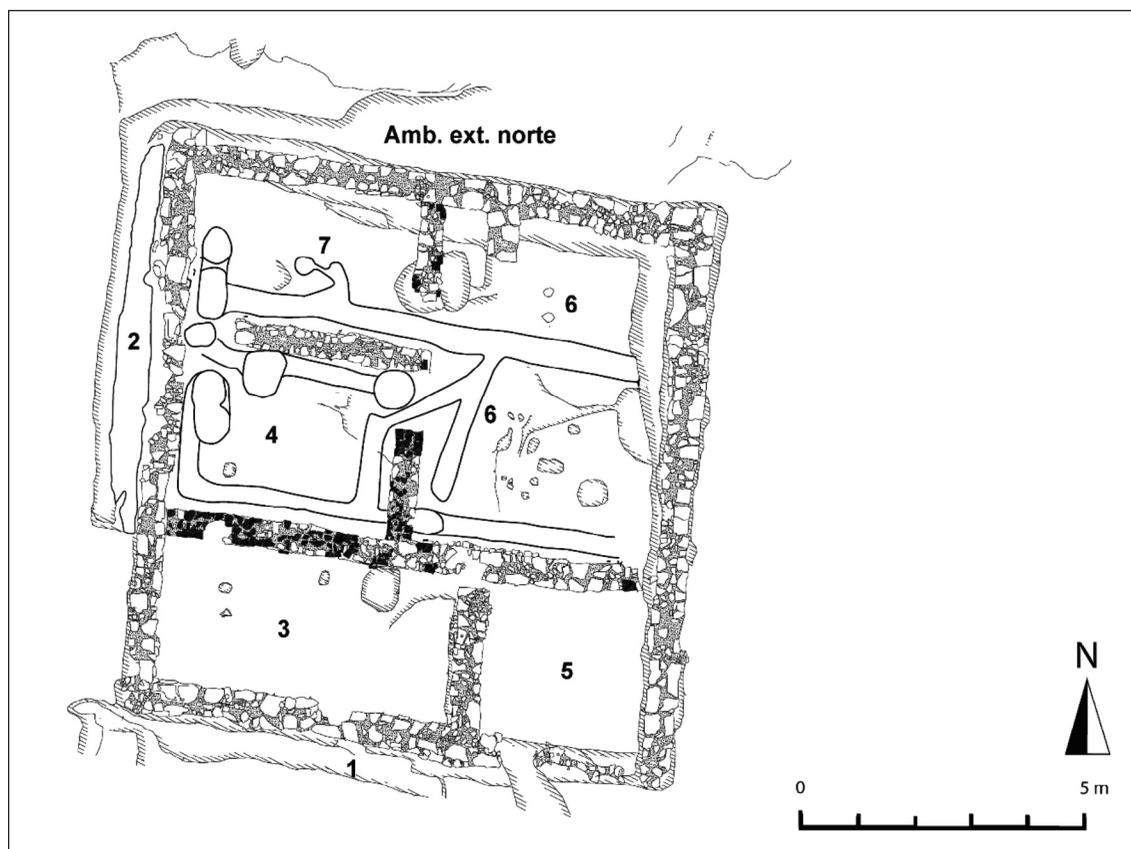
Planta esquemática da construção nº 1 com implantação (linhas pretas) dos drenos internos nos ambientes 4, 6 e 7.
